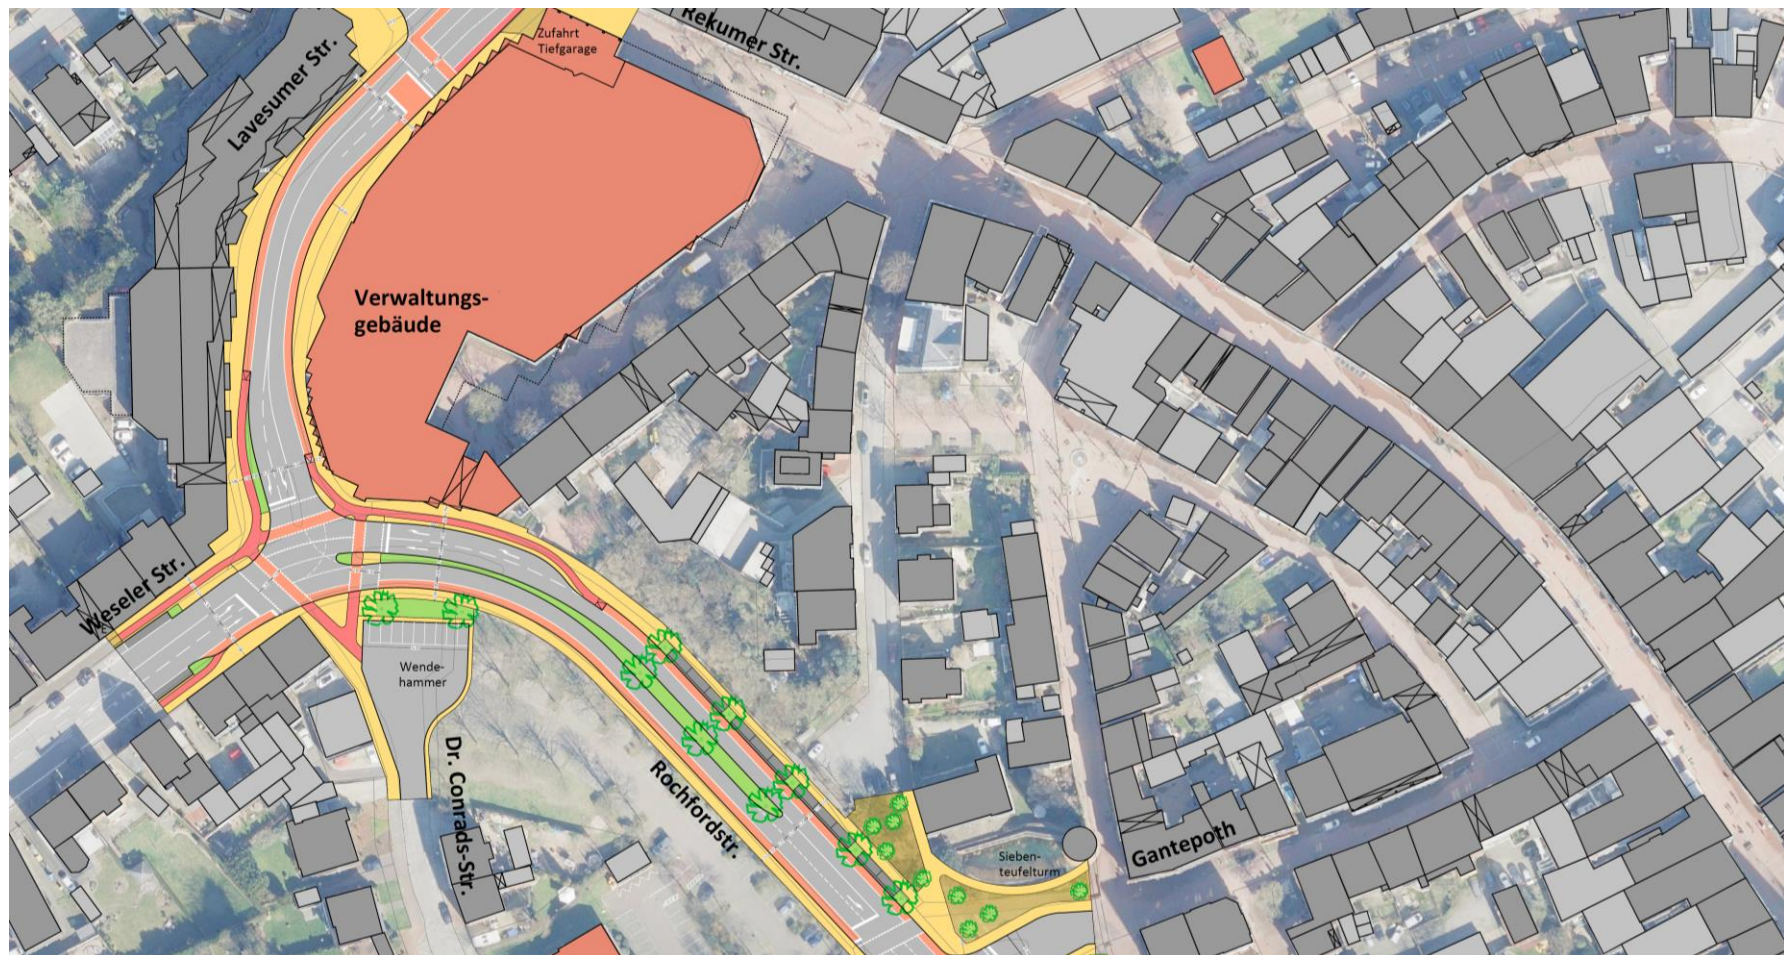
Abschnitt 2: Rochfordstraße von der Schmeddingsstraße bis Lavesumer Straße
